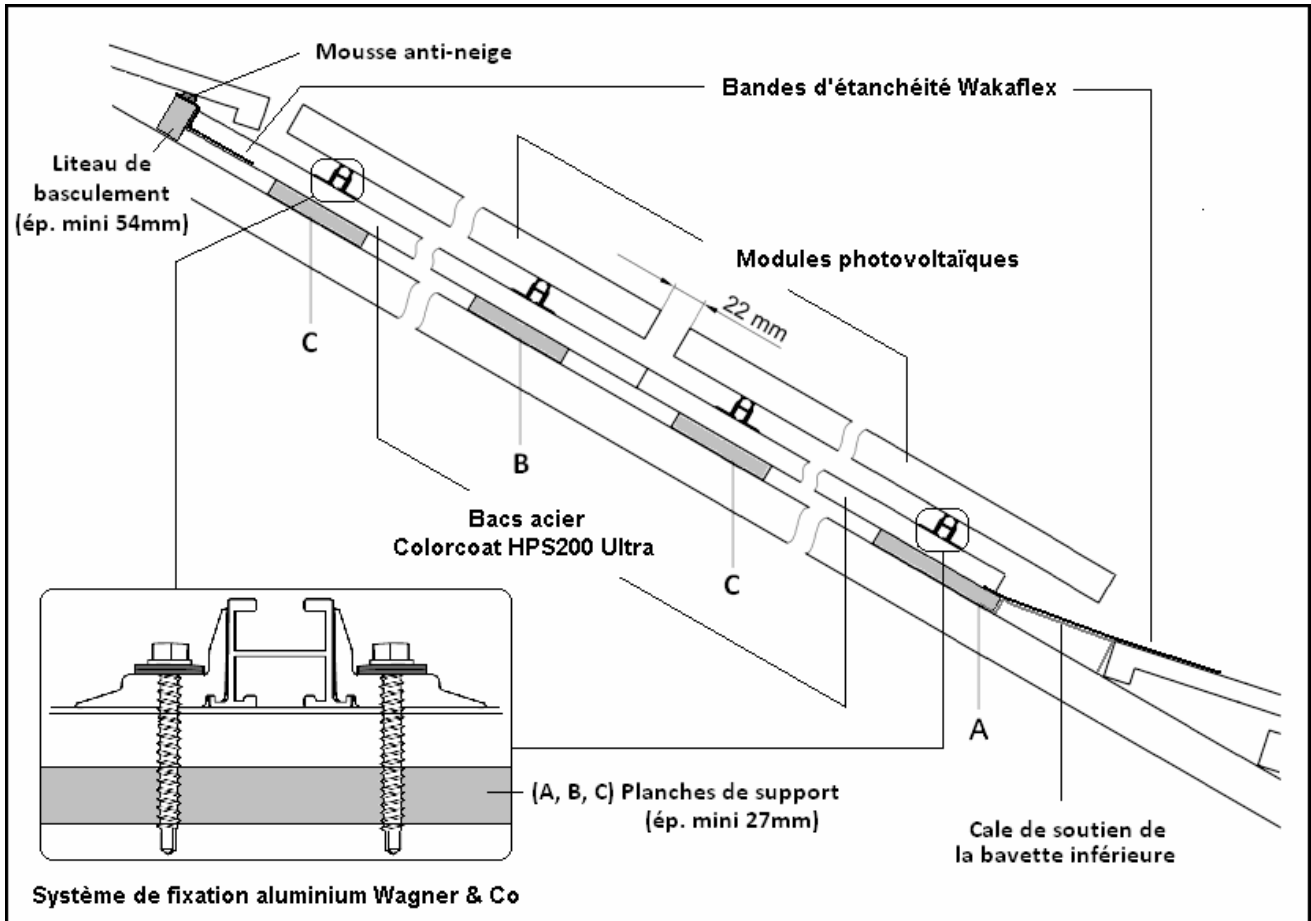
Plan en coupe de la toiture, présentation du montage des bandes d'étanchéité Wakaflex
